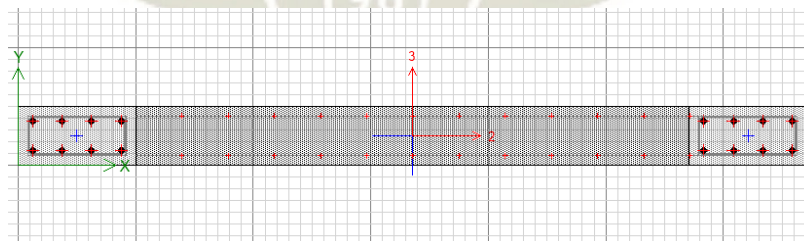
Sección de diseño de P-2 (Elaboración propia)
